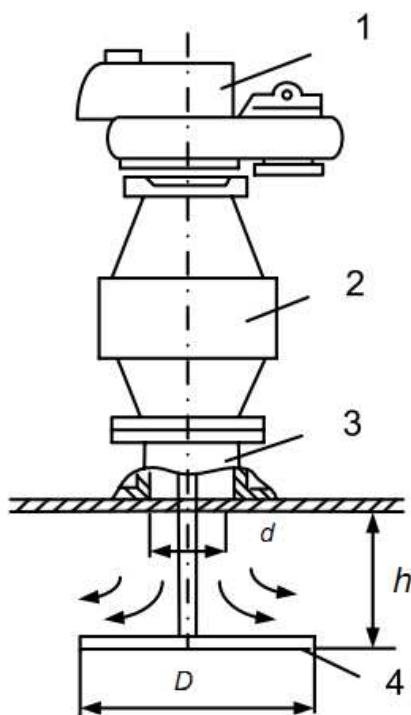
Установка диска-отражателя на резервуаре:
